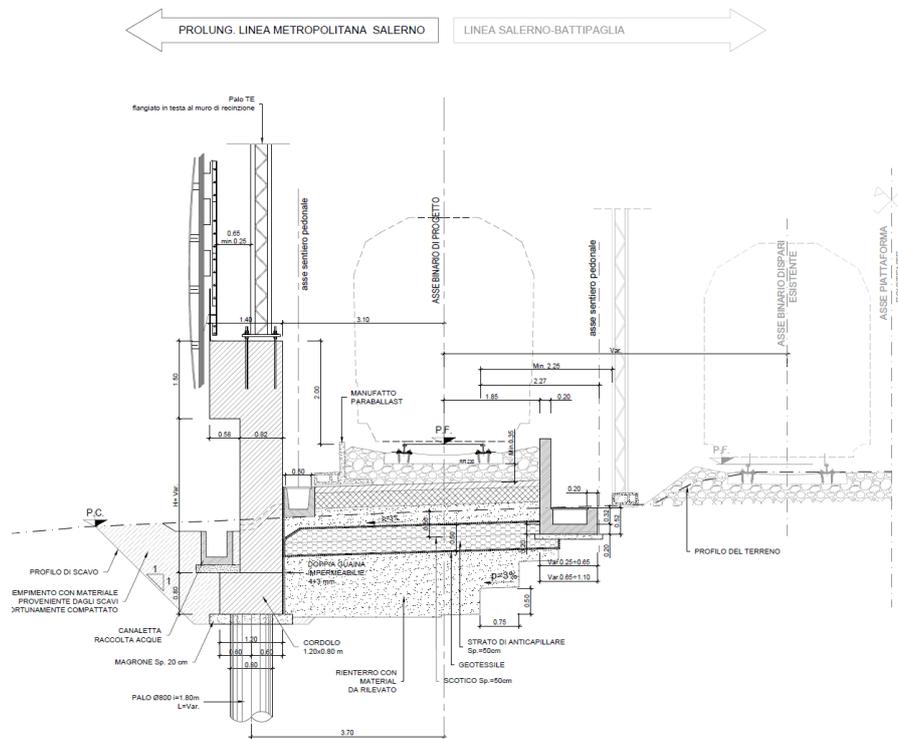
Sezione Tipo 1 - Sezione in rilevato in affiancamento con muro di recinzione in stretto affiancamento con barriera antirumore e palo della TE.
